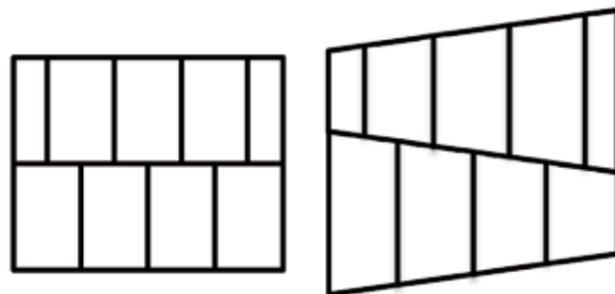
Pianta degli anelli di rivestimento rettangolari e trapezoidali
